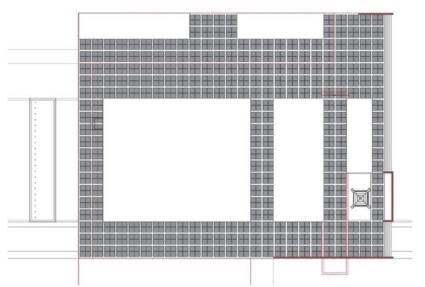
A. Planta de trama pavimentos, Plaza Acceso. Fuente: elaboración propia
